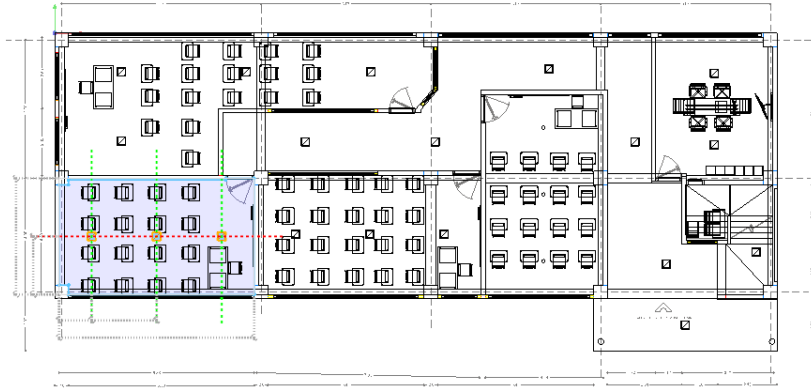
Incorporación de luminarias LED dimerizables en la planta baja
